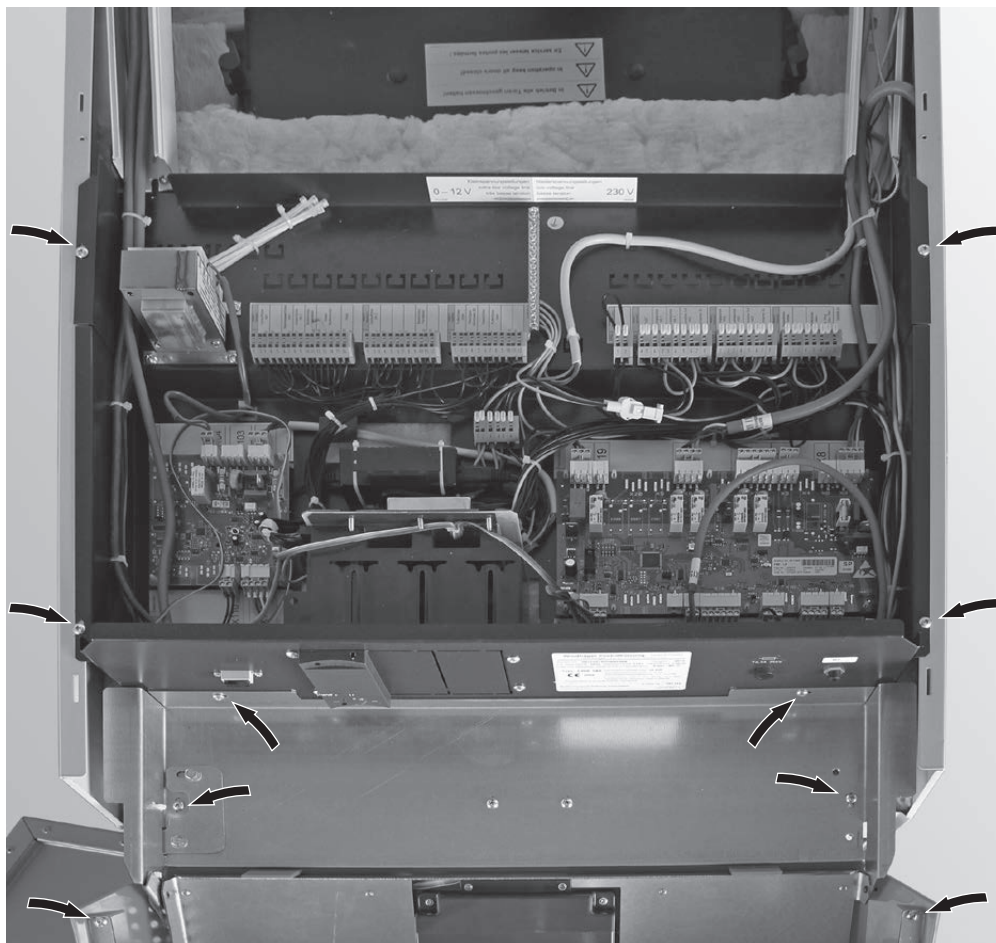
Aggiustare il rivestimento, serrare tutte le viti
